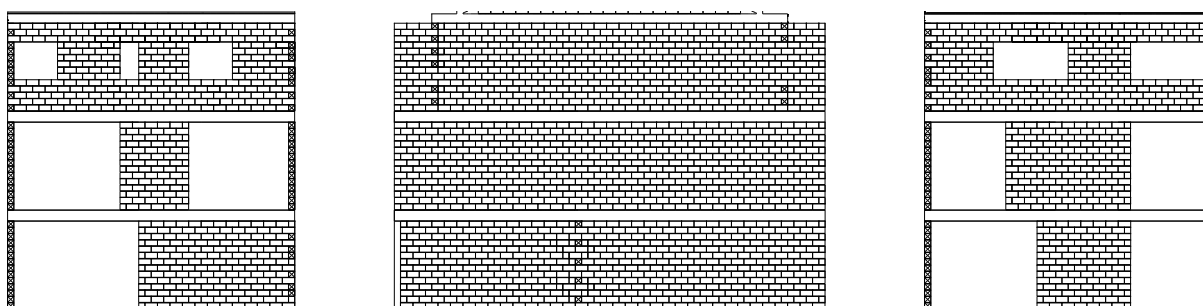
Modulação estrutural das fachadas da moradia em Bragança
